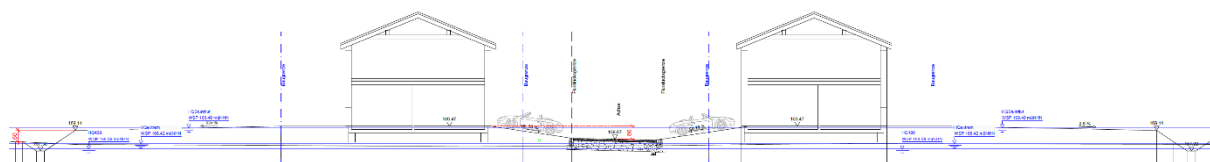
Schnitt durch Planstraße und Grundstücke mit dem Kennbuchstaben A bzw. Messpunkt Nr. 10 mit öffentlichen Entwässerungsmulden (rechter und linker Bildrand)
